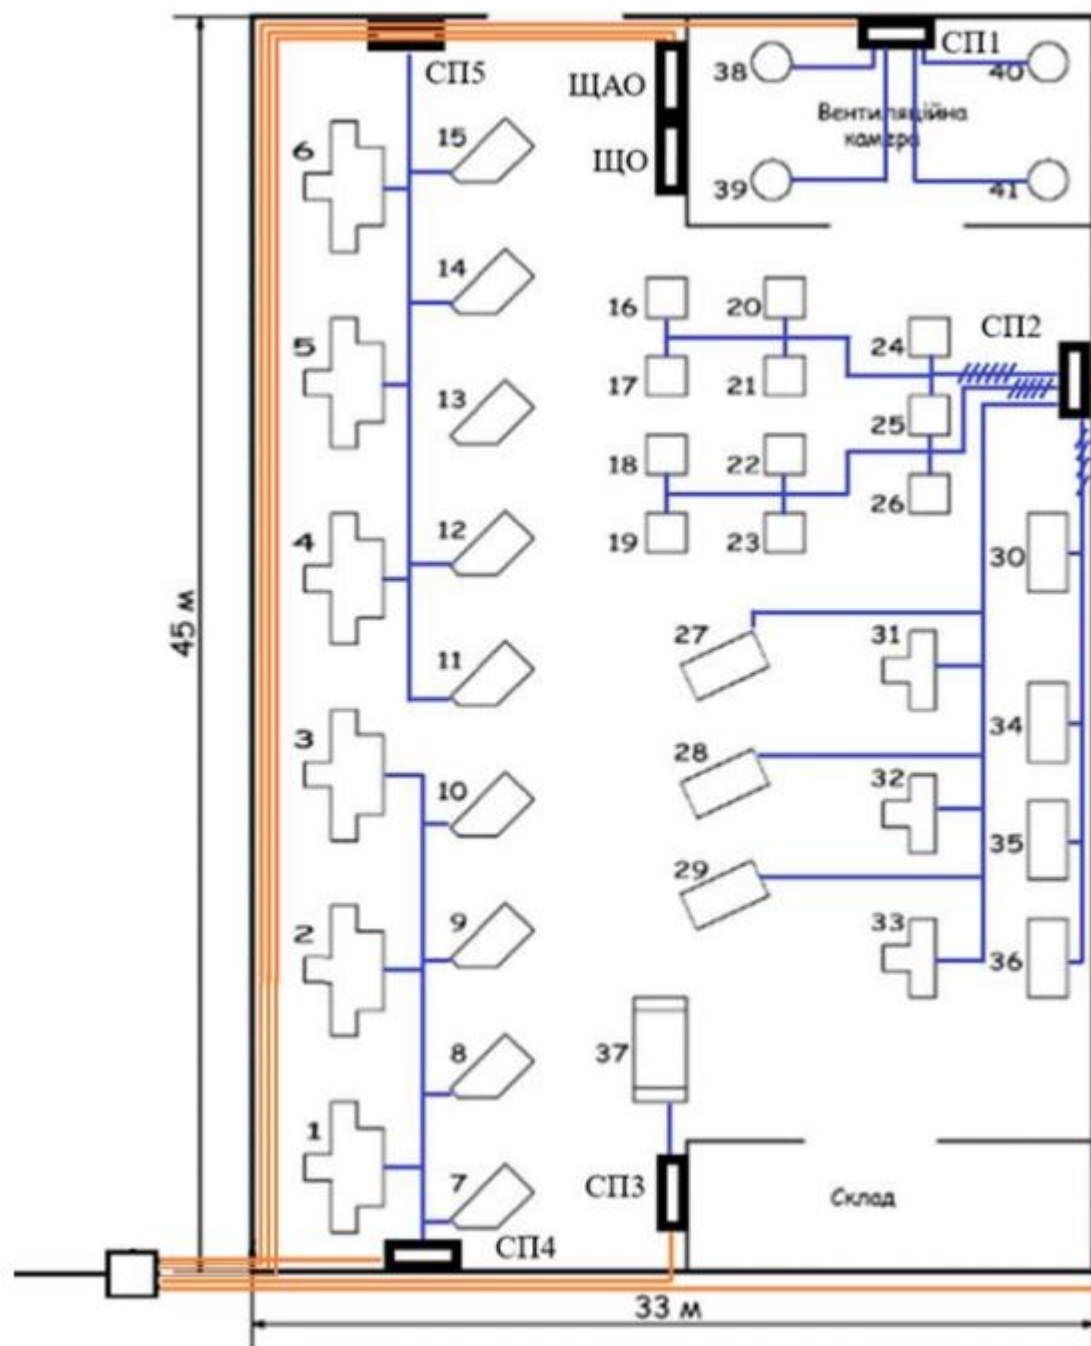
План розміщення ЕП цеху обробки корпусних деталей
